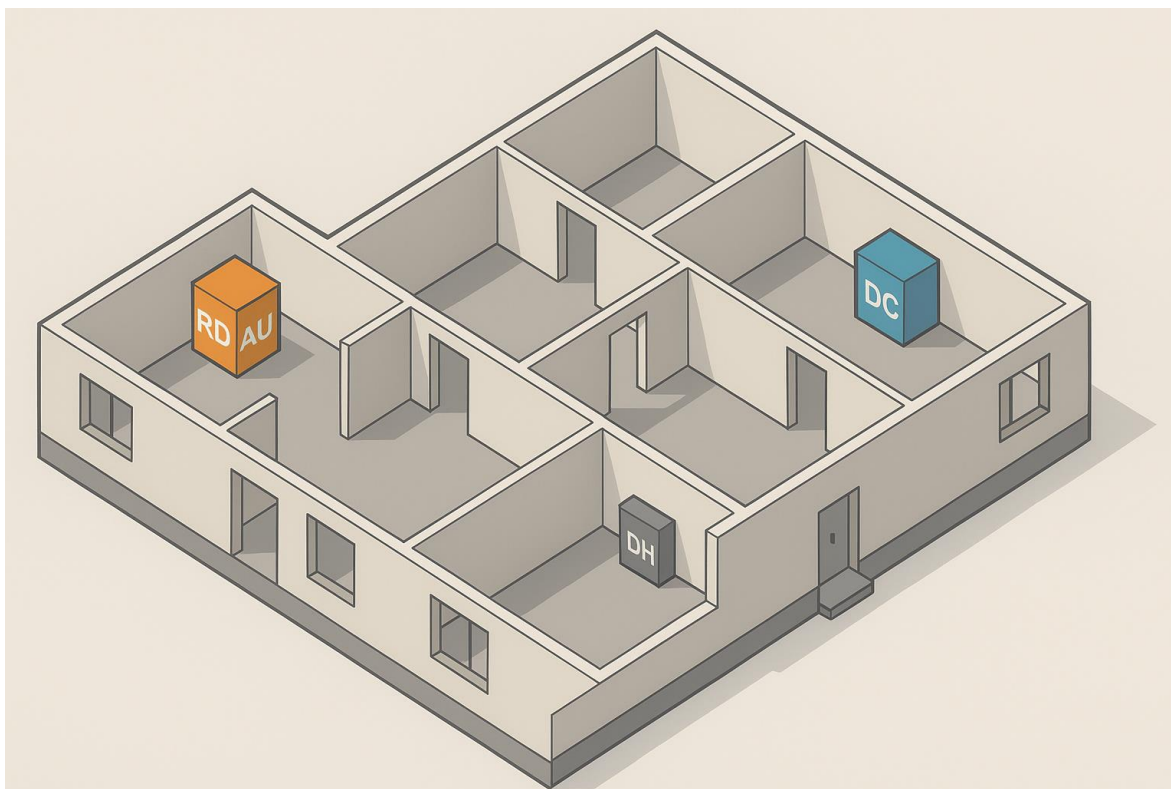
Компонування вузлів у будівлі (монтажна схема)
